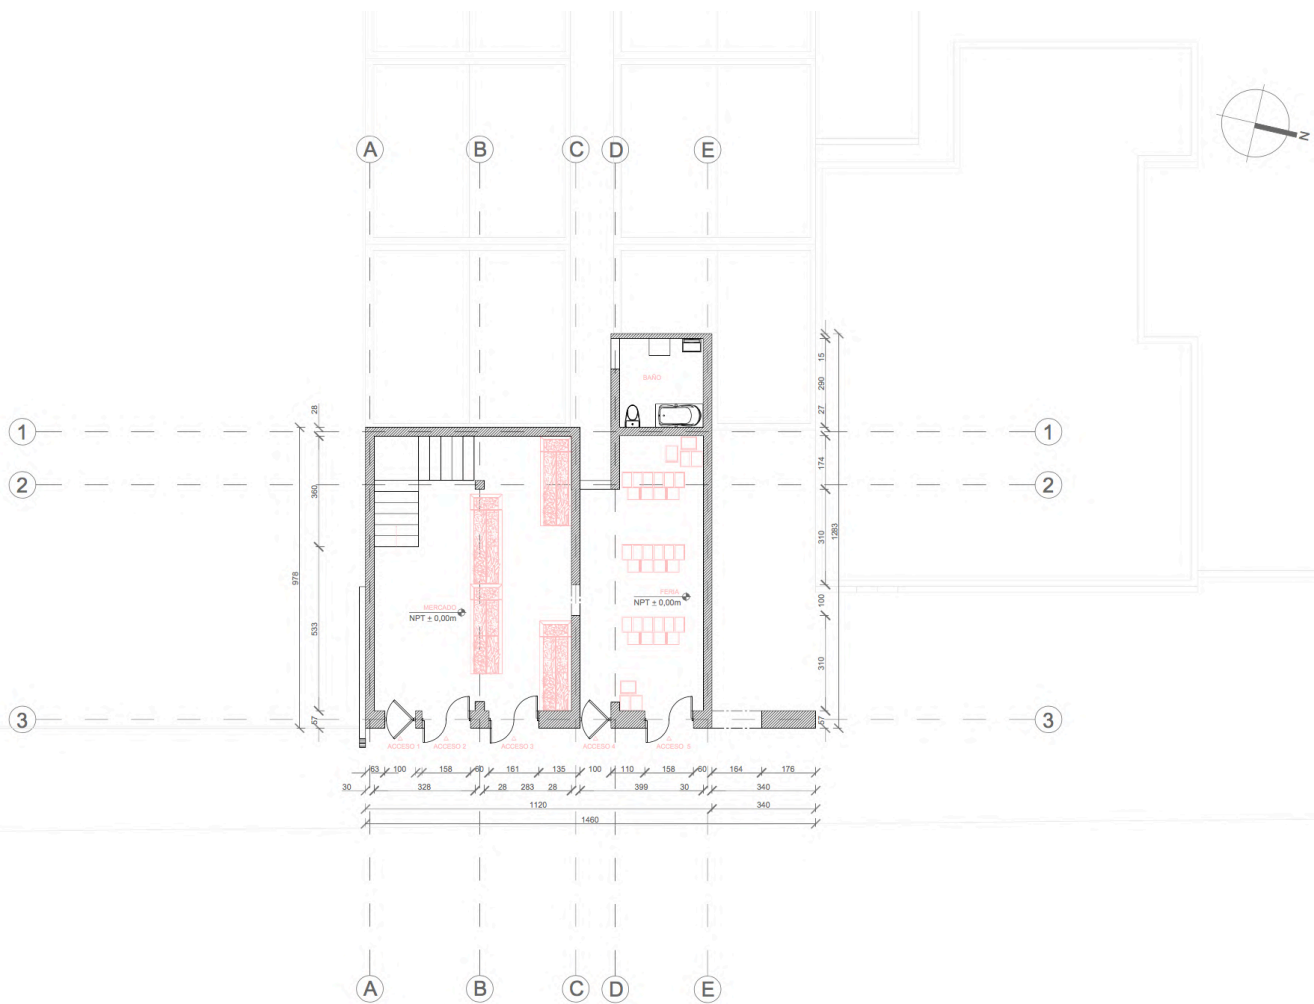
Prótesis 01, planta primer piso. En rosa, la intervención de la prótesis, en gris lo existente.
